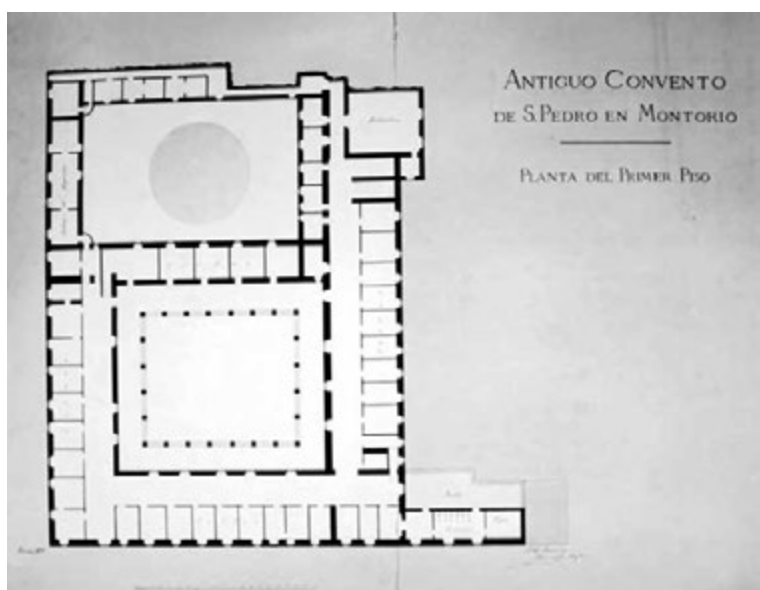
Alejandro del Herrero y Herreros, rilievo del primo piano del convento, 1879, MAAEE, *San Pietro in Montorio, Pensionado 1867-1870, Titulado 1871, Obras de la Academia 1879-1881
